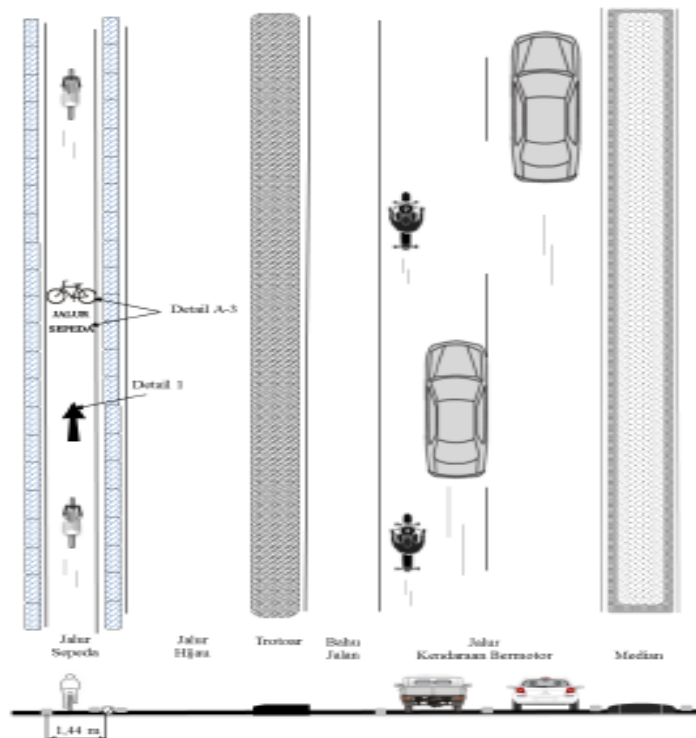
Tampak atas jalur sepeda tipe A di badan jalan yang memiliki tempat parkir kendaraan bermotor
